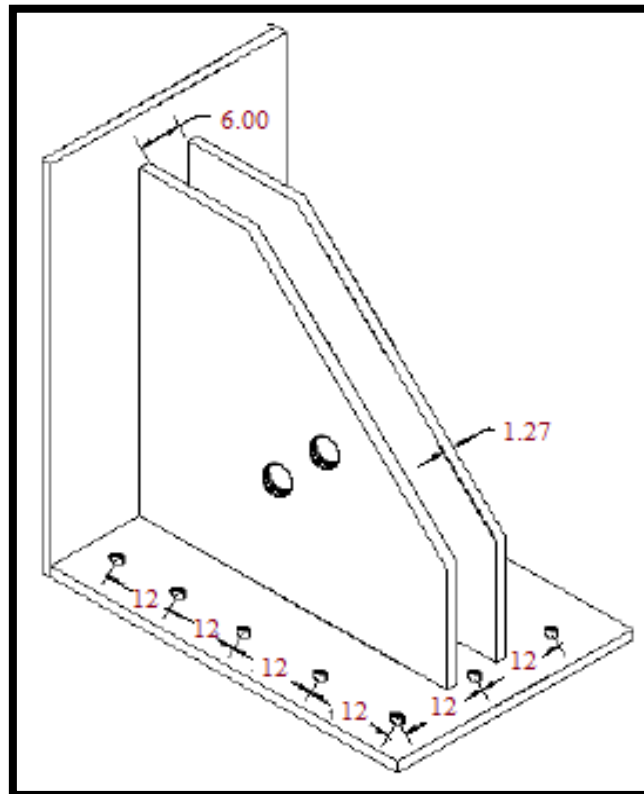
Detalle final de la plancha metálica. Fuente: Propia.
